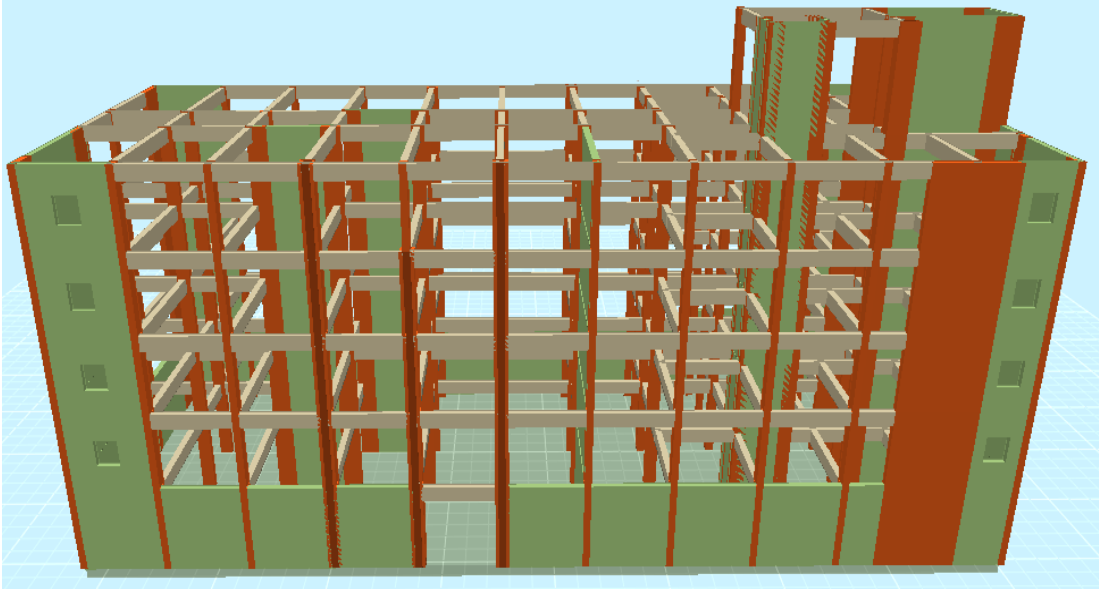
Yeni eklenen betonarme perdelerin ve mantolanan kolonların kat planı üzerinde gösterilmesi
